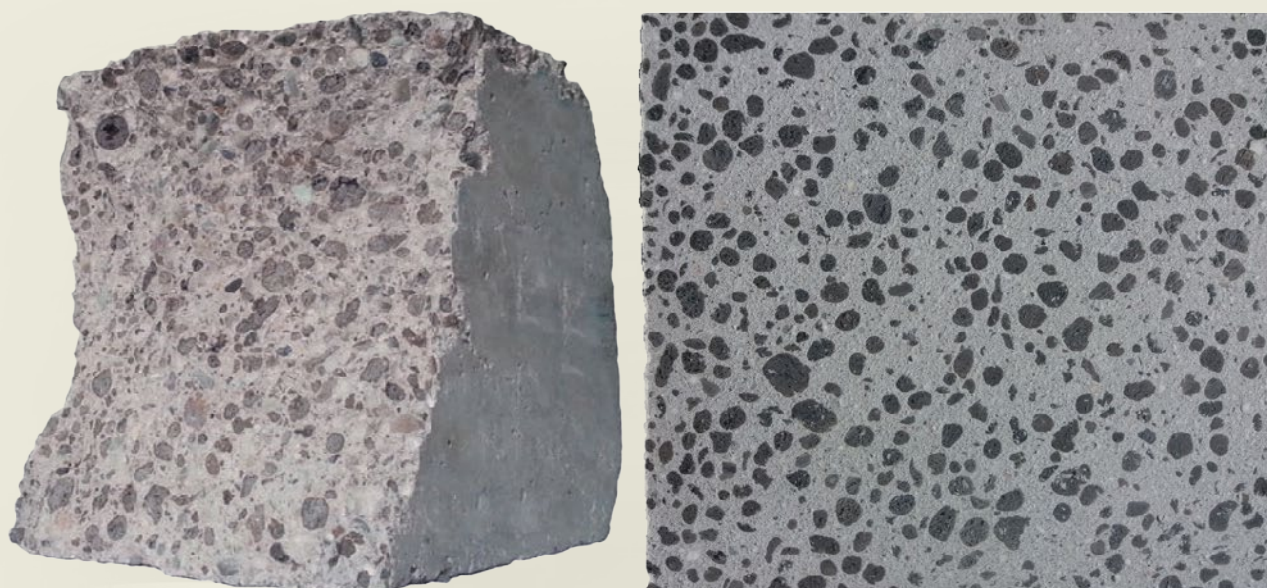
Przykłady elementów prefabrykowanych z betonu lekkiego (www.leca.asia)
